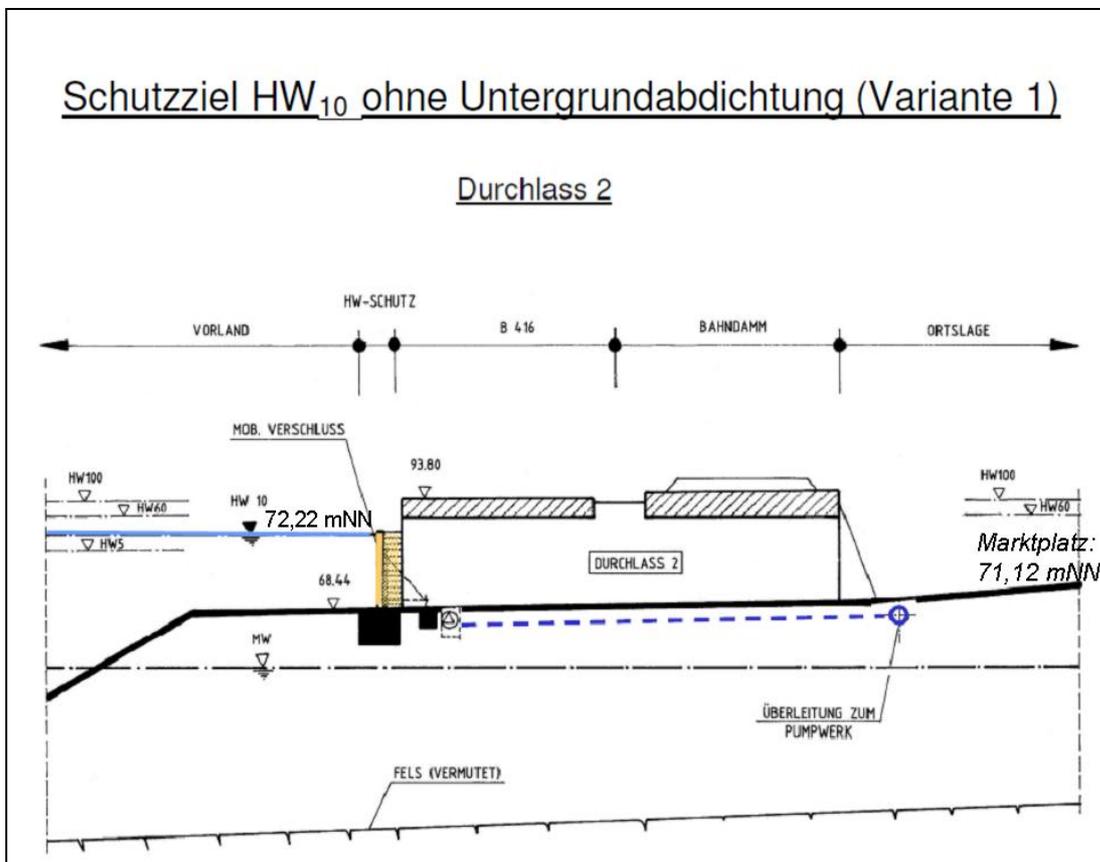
BCE-Variante 1.1: HW10 ohne Untergrundabdichtung: Querprofil
